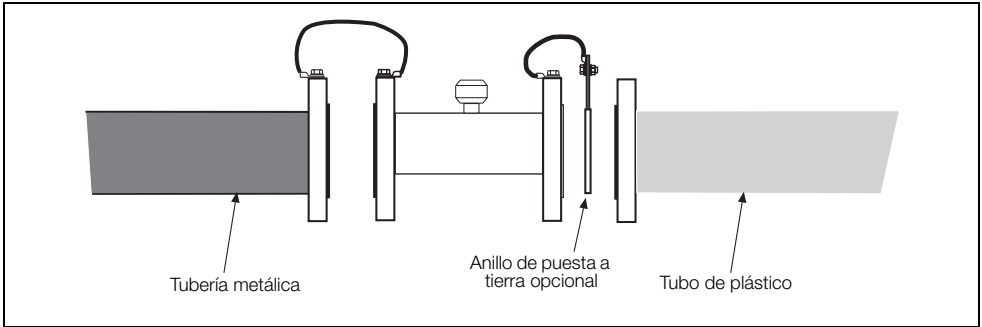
Tubería de metal con brida a tubería de plástico
